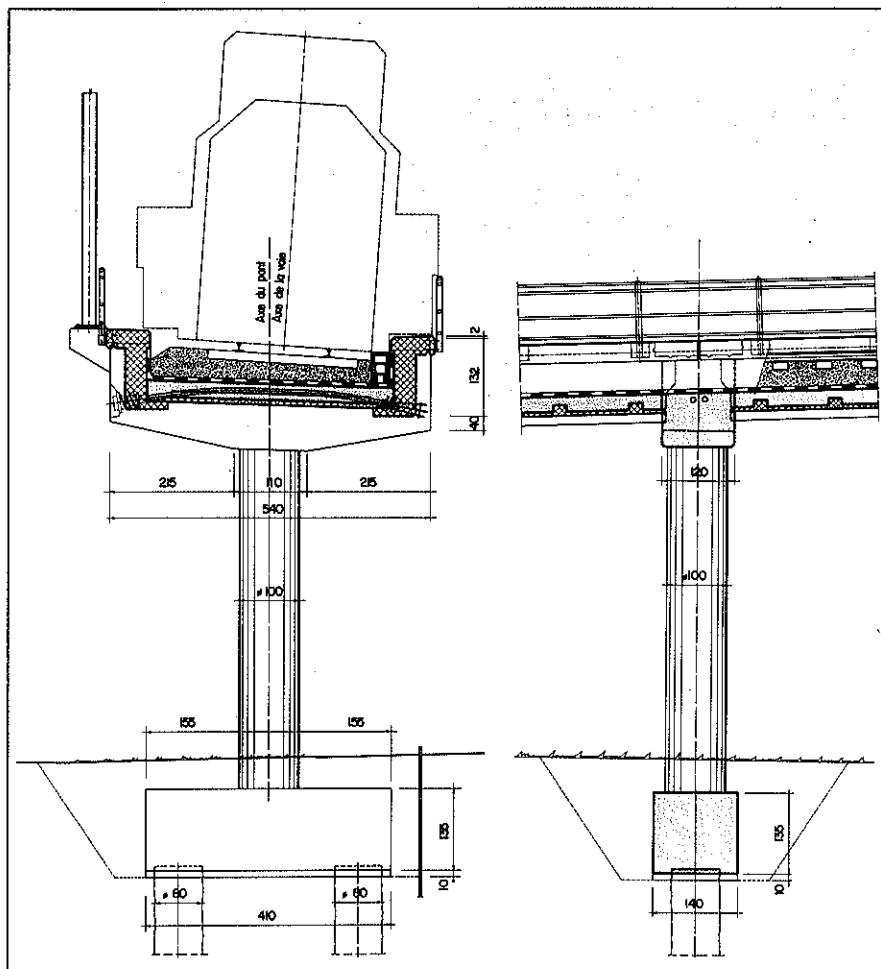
Pont de La Bourdonnette: coupe en travers et détail de la coupe en long.
